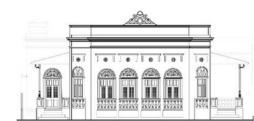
Trecho do corte JJ presente no desenho 31 da prancha 10 com locação proposta para caixa d'água
